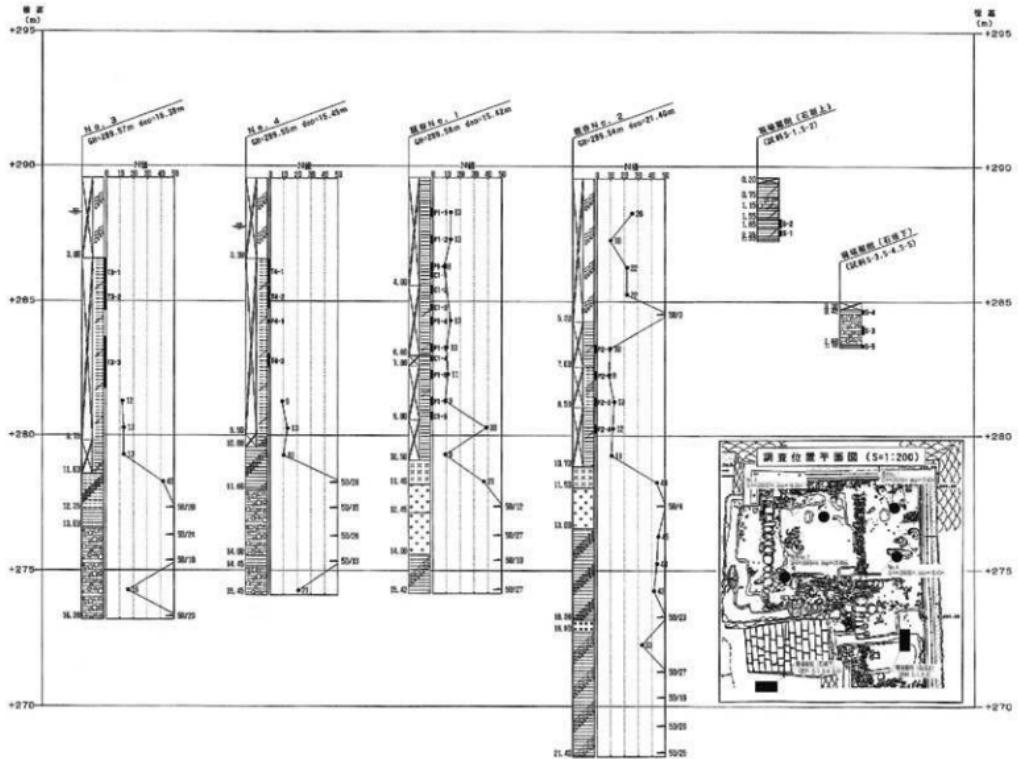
室内土質試験試料採取位置図 (SV: 1:100、SH:一覧表示) (調査位置平面図拡大図は前掲)
